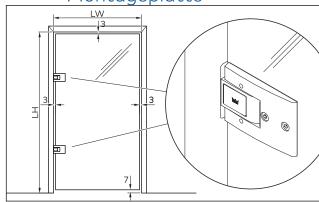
Spaltmaße für Zargenbefestigung mit eingelassener Montageplatte
